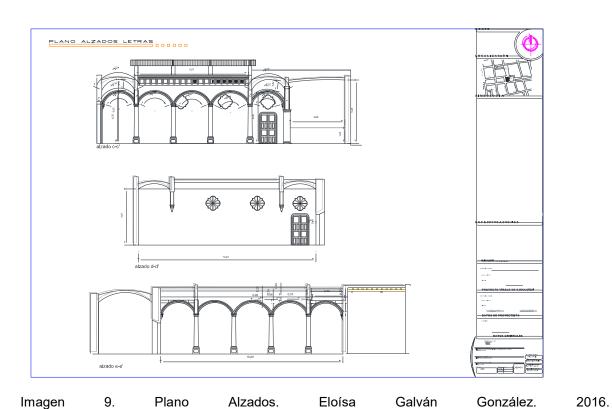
Plano de Alzados. Eloísa Galván Gonzalez. 2016.
